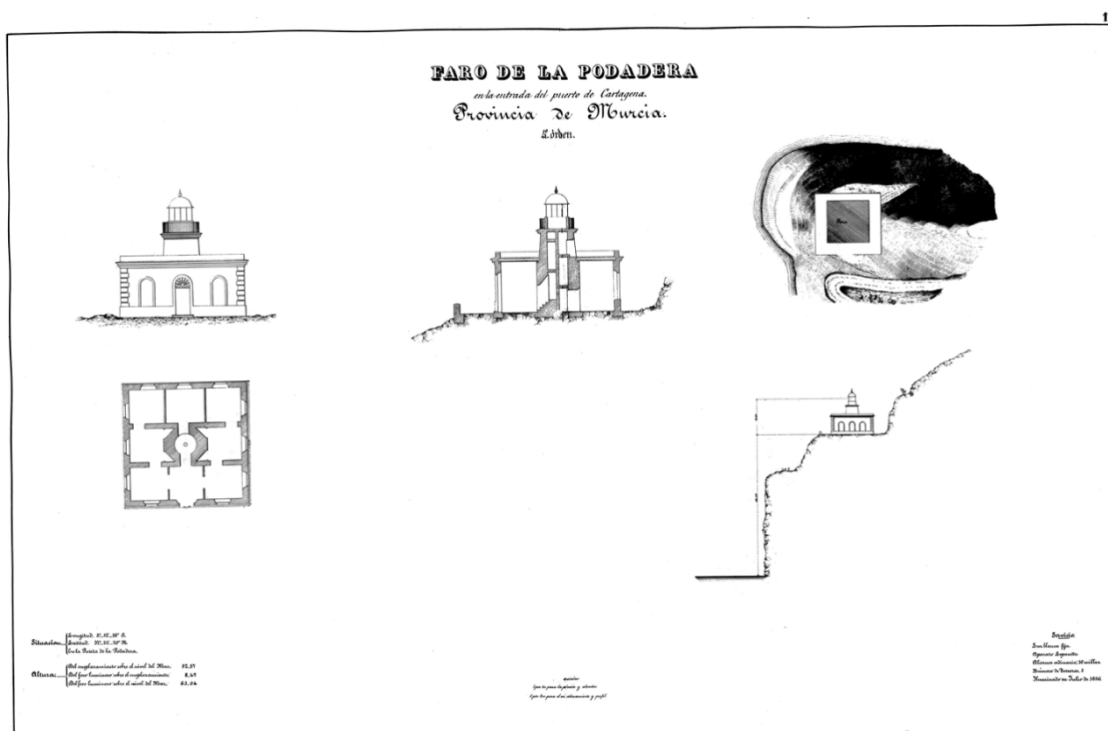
Plano del Faro de la Podadera en 1878. Fuente: OO.PP., 1878.¹⁷
